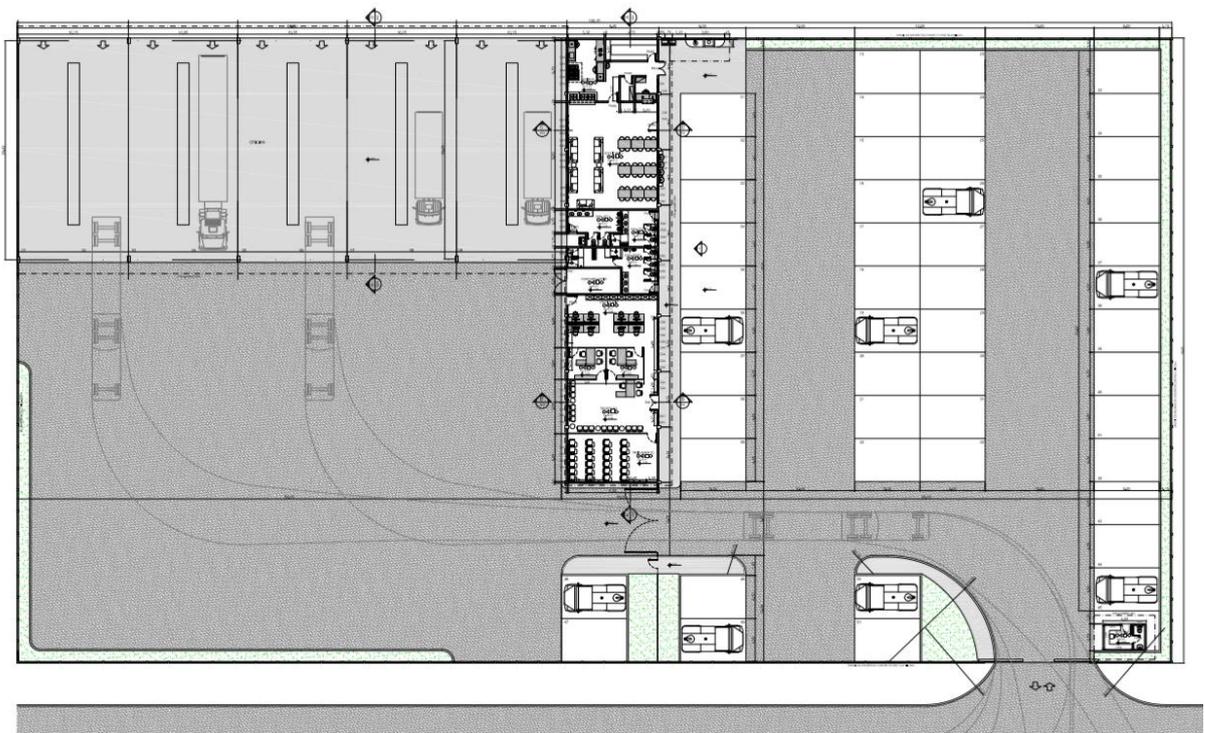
Projeto Arquitetônico, planta baixa de implantação geral
